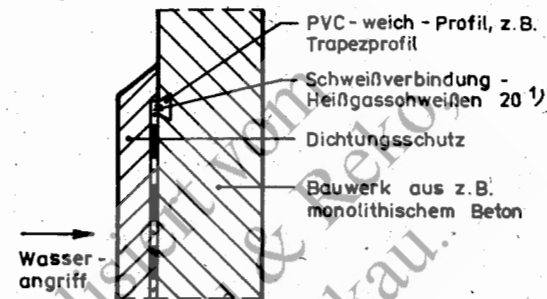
Dichtungsabschluß über PVC - weich - Profil
